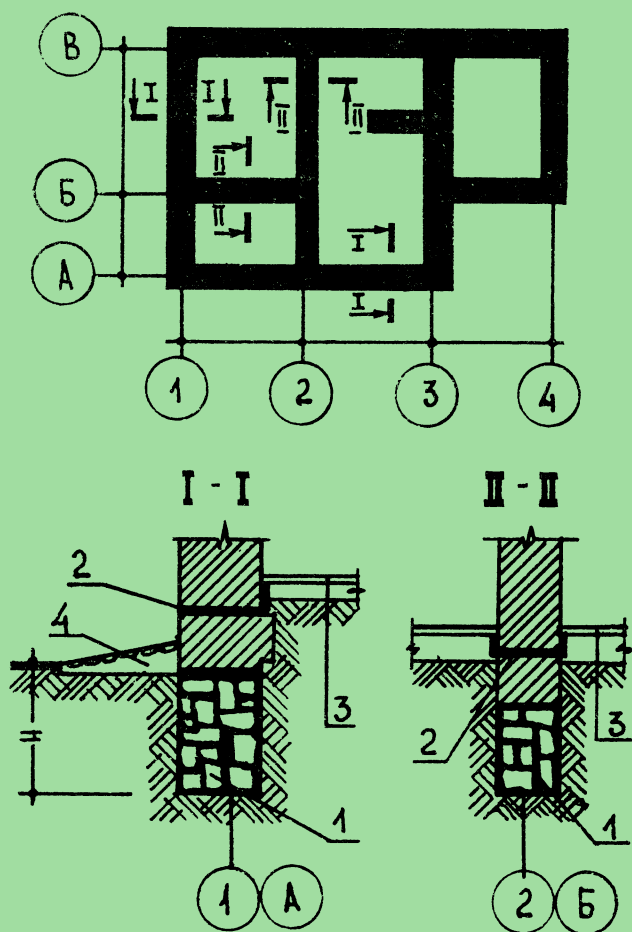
Монолитный (бутобетонный) ленточный фундамент:
